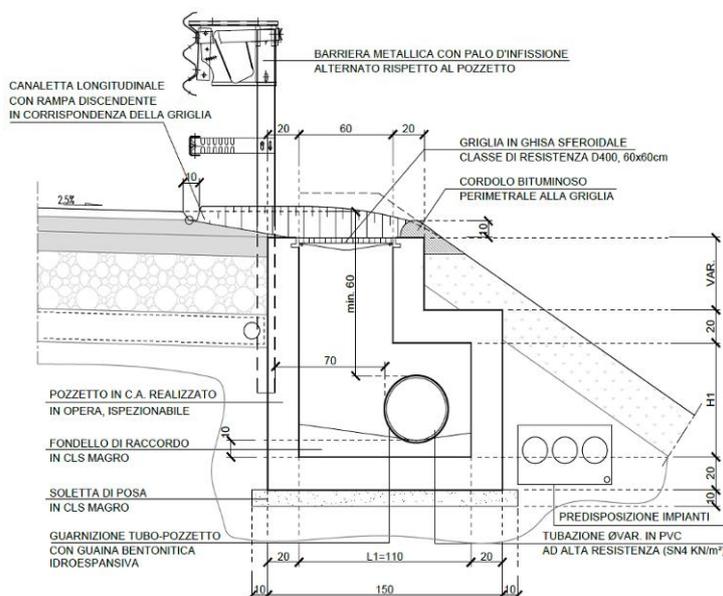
SEZIONE POZZETTO DI RACCOLTA ACQUE DI PIATTAFORMA IN RILEVATO
